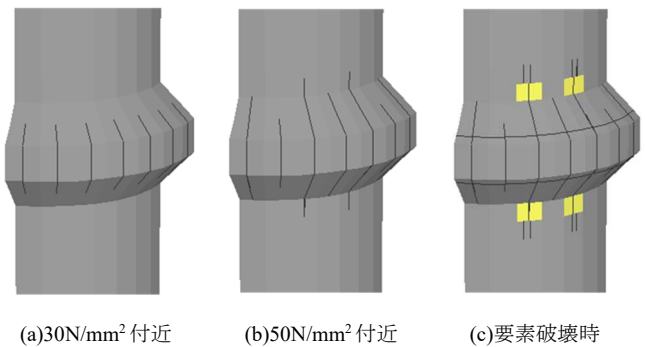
ひび割れ状況 (A-1 (節標準))
